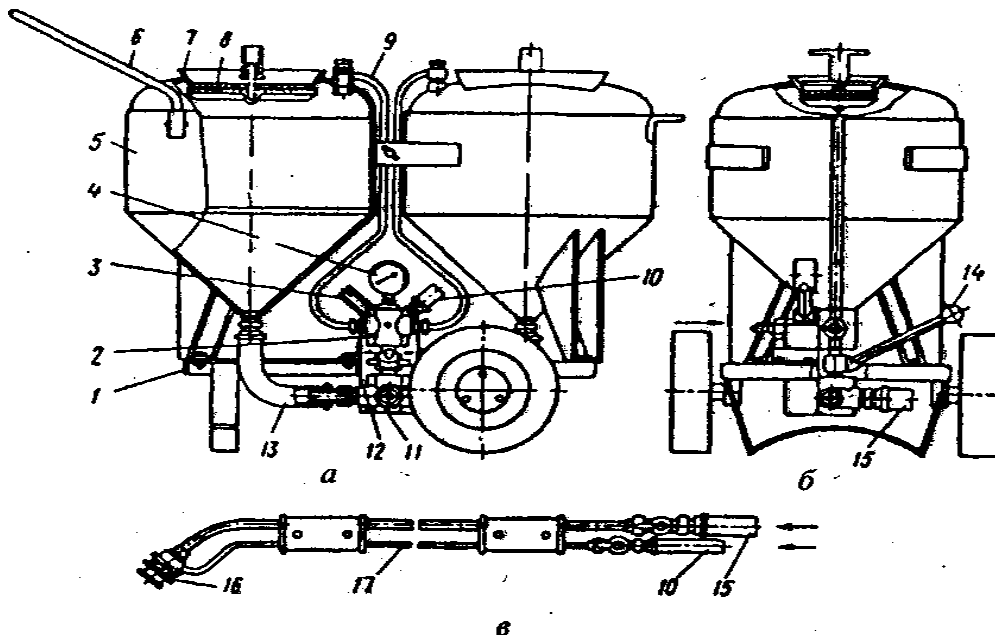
Пневматическая установка 7 СО-21А для нанесения жидкой шпатлевки:
